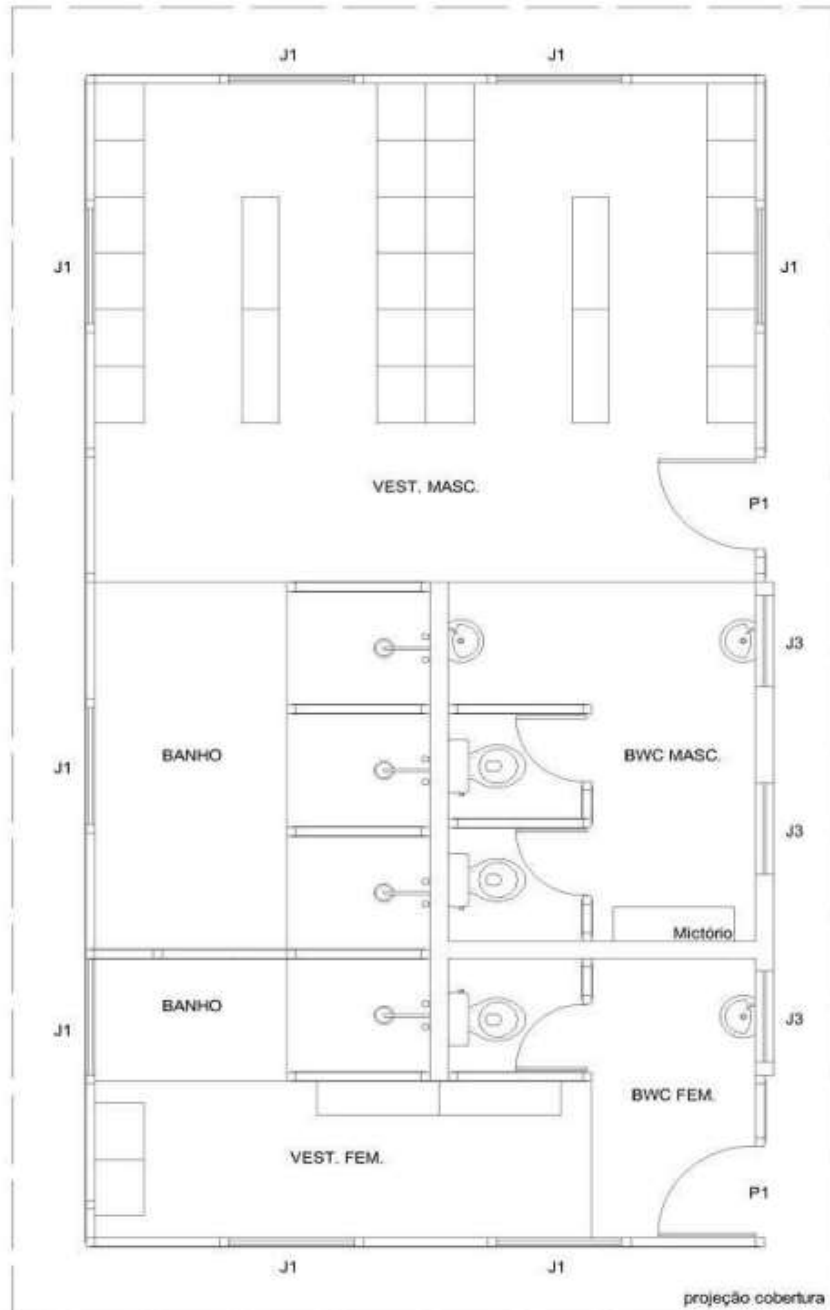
Layout* de referência de sanitário e vestiário em canteiro de obra, em c madeira compensada, utilizado para fins de especificação.
